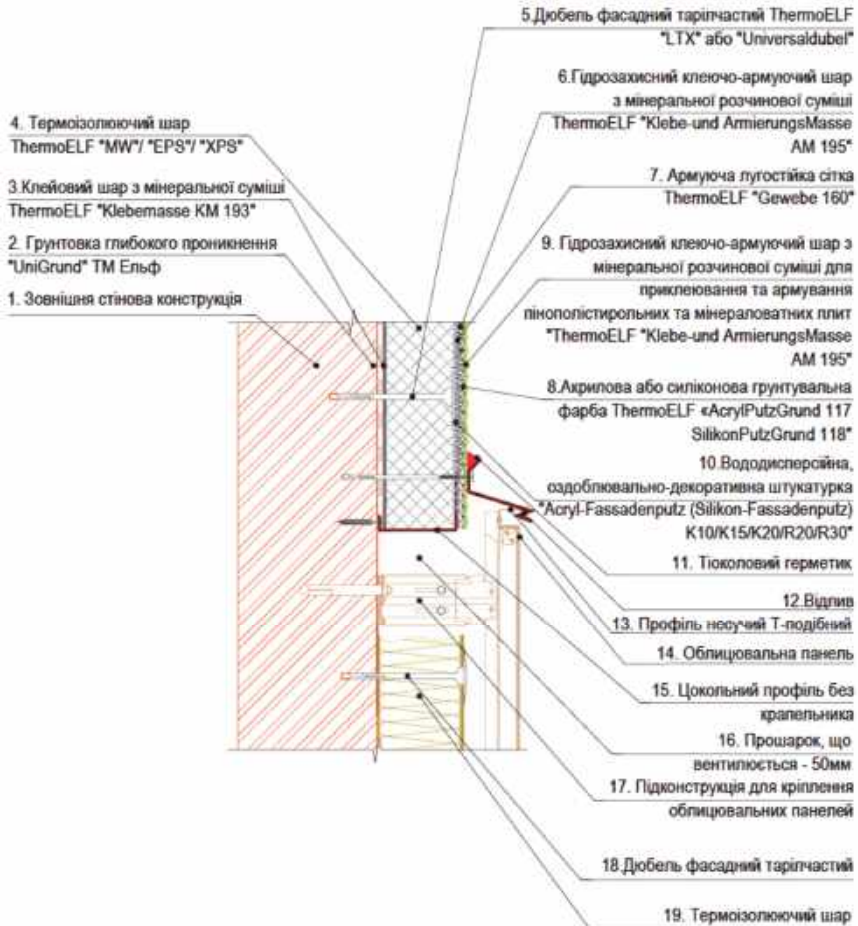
Вузол 7. Горизонтальний стик штукатурного та вентиляваного фасаду
